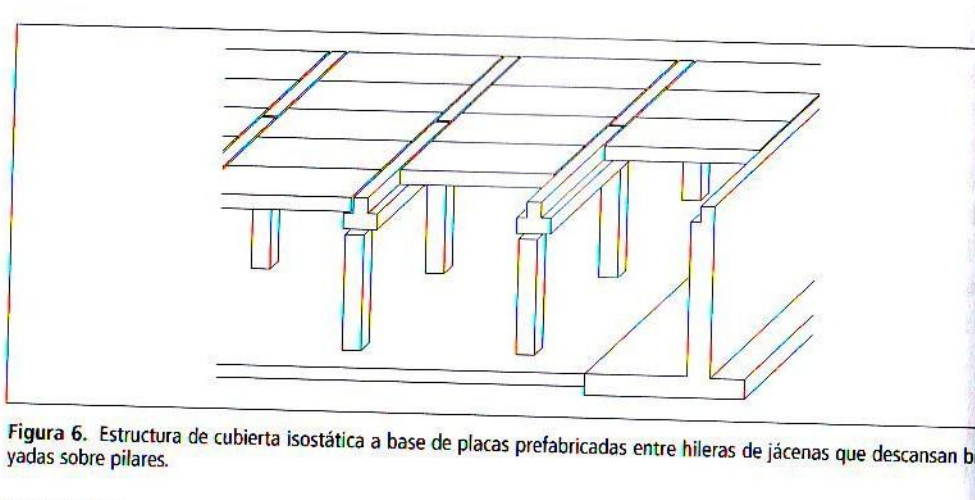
Estructura de cubierta isostática a base de placas prefabricadas entre hileras de jácenas que descansan sobre pilares.
